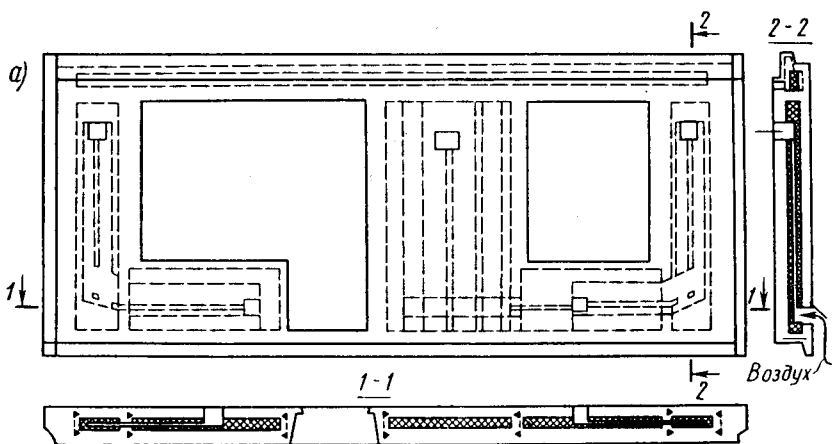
Трехслойная бетонная вентилируемая панель:
